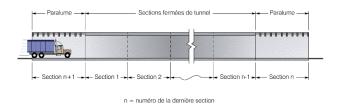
Sectionnement d'un tunnel avec paralumes
